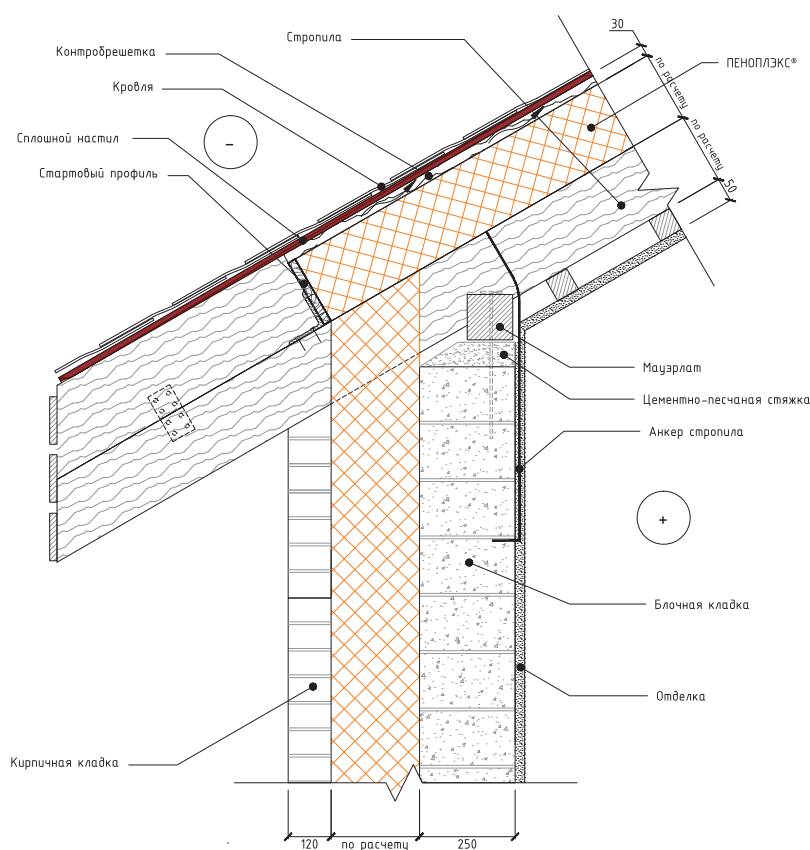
Схема примыкания теплоизолированной стены из облегченных блоков к стропильной системе скатной кровли.
